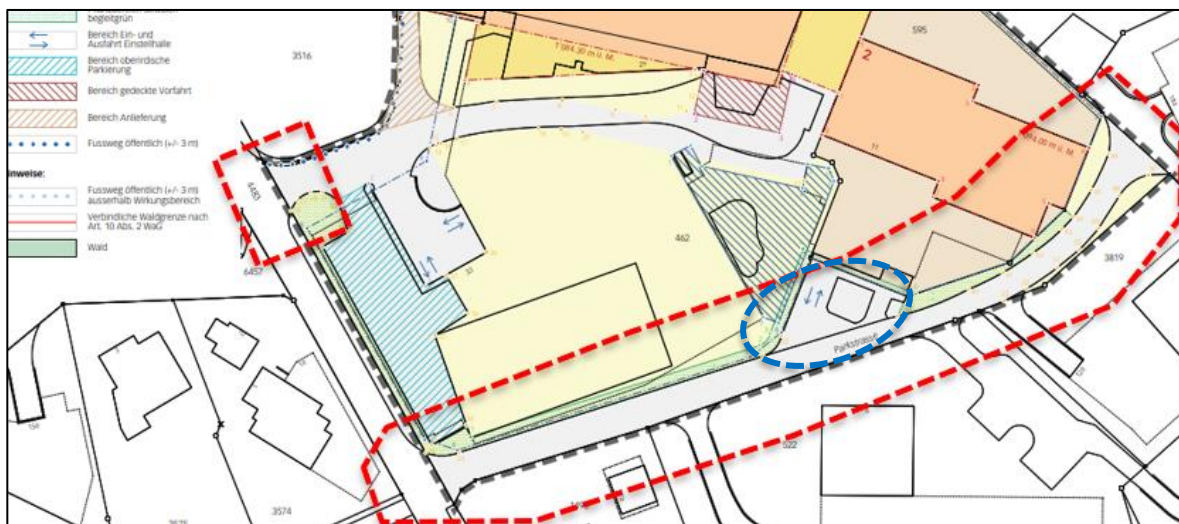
Ausschnitt Plan Überbauungsordnung (rote Umrandung = Projektperimeter RSA gem. Vorprüfungsbericht; blaue Umrandung = Bereich Einstellhallenausfahrt)
